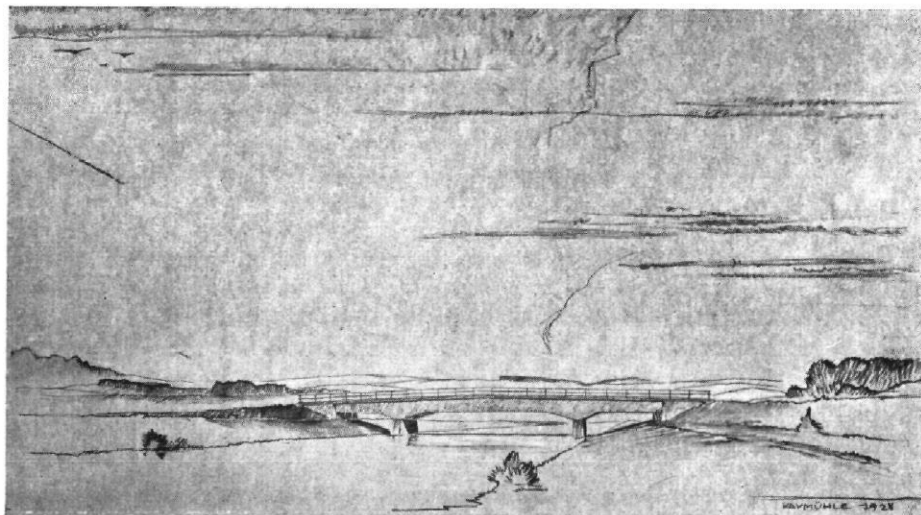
| Brücke in Kaymühle (ausgeführt) | Architekt: Reg.-Baumeister Adolf Schubmacher, Stuttgart | Ingenieur-Firma Beton-Monier-A.G., Stuttgart
